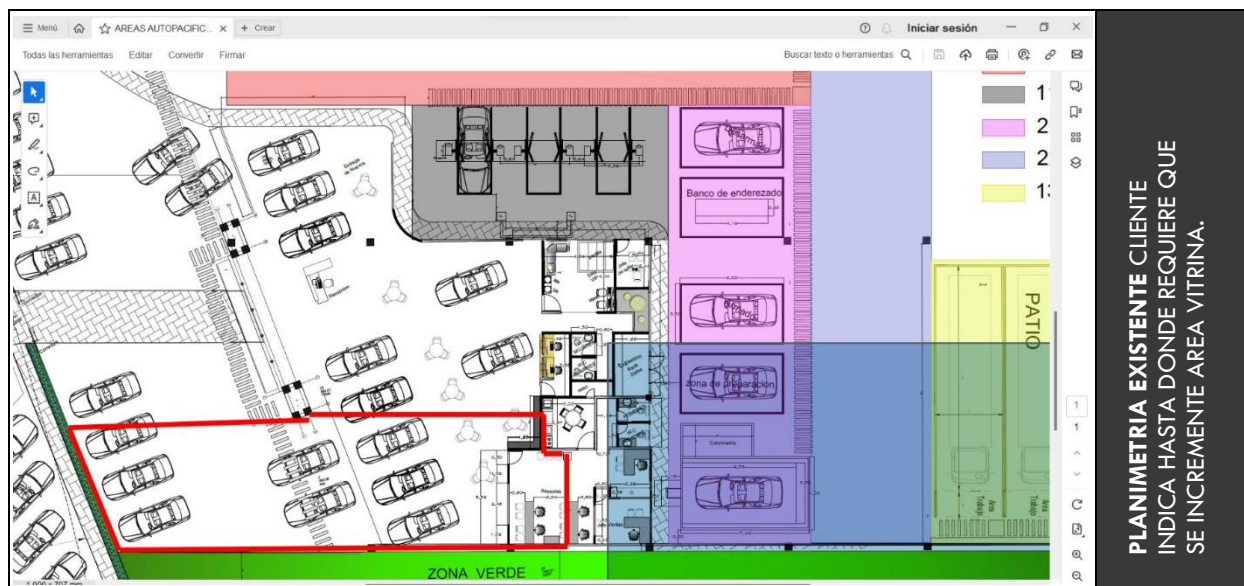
Planimetría existente cliente indica hasta donde requiere que se incremente área vitrina.
